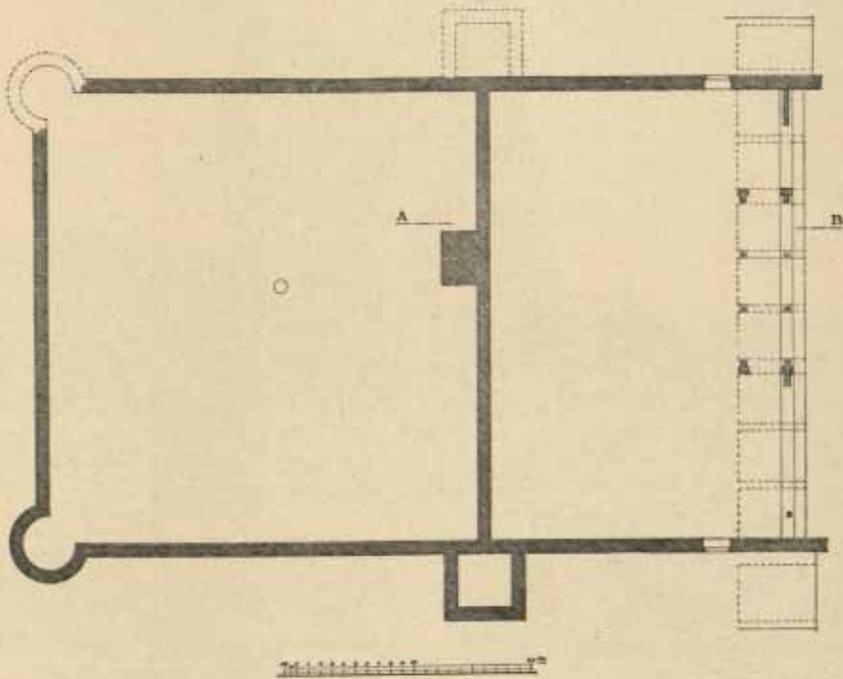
Al-Mwaķķar. Grundriß des Schlosses.
